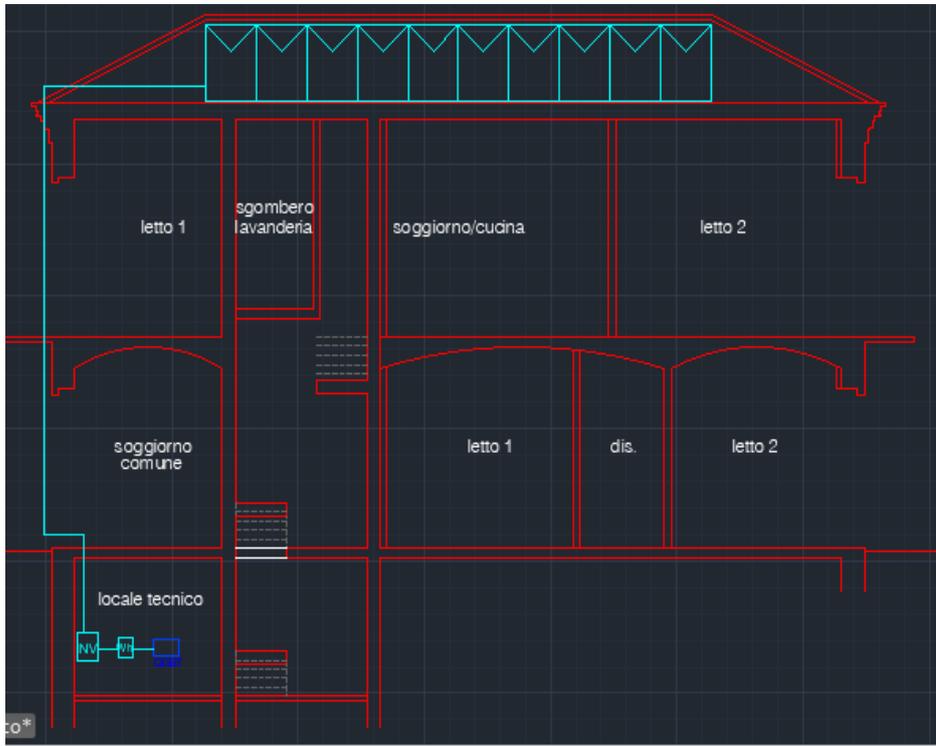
Disposizione moduli sul tetto e layout dell'impianto fotovoltaico
